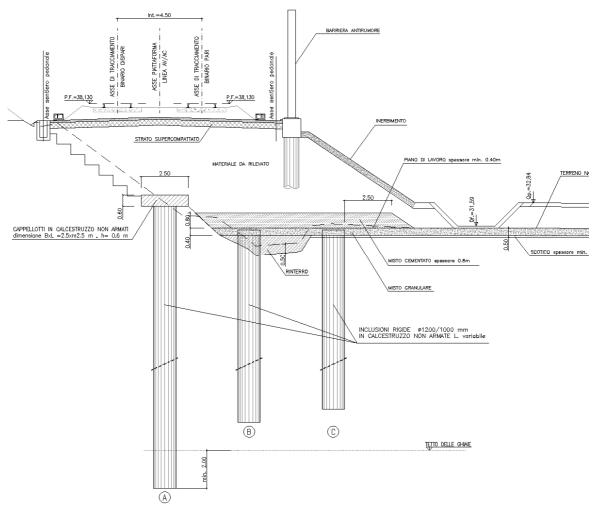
Progetto Esecutivo - sezione di intervento Ri60
